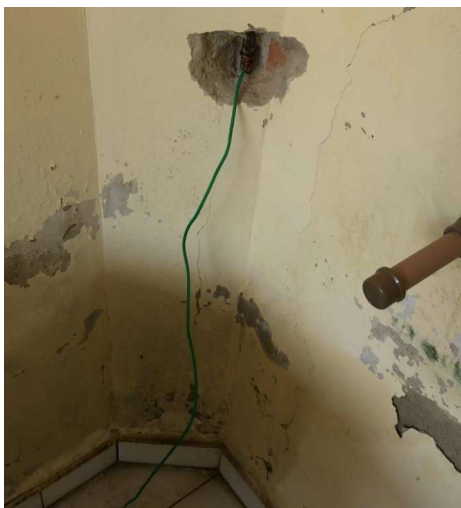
Conexão do condutor verde ao eletrodo de aterramento proposto (armadura do pilar).
